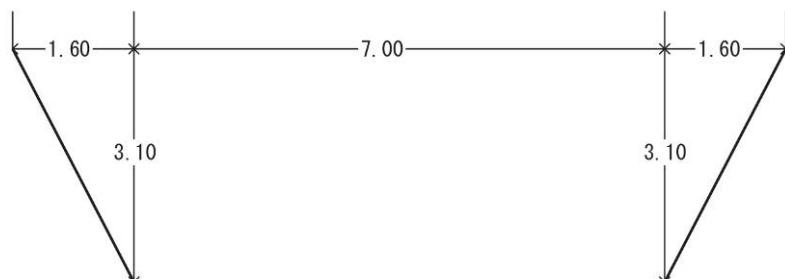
(3) 水路断面 (No. 3) (斎勝川下流)
